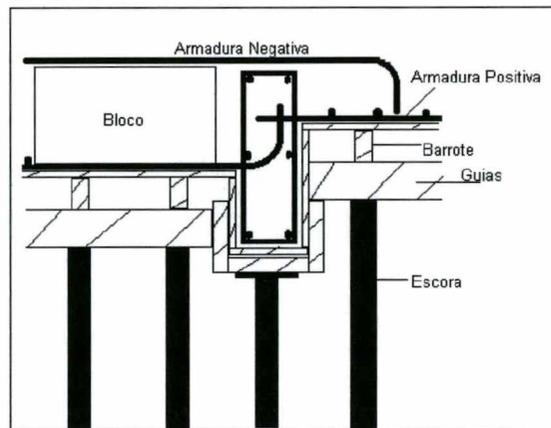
Corte do engastamento da laje nervurada, com fôrma de madeira e escoramento metálico.
